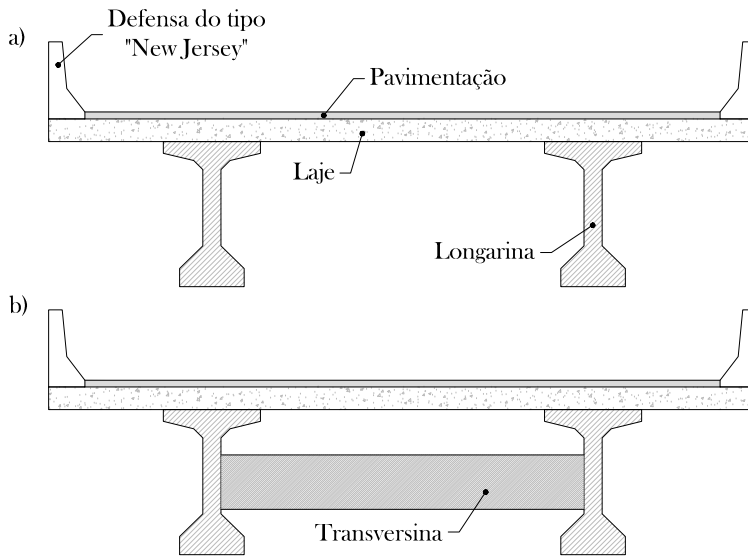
Seção para pontes em viga de concreto: (a) sem transversinas; (b) com transversinas.
